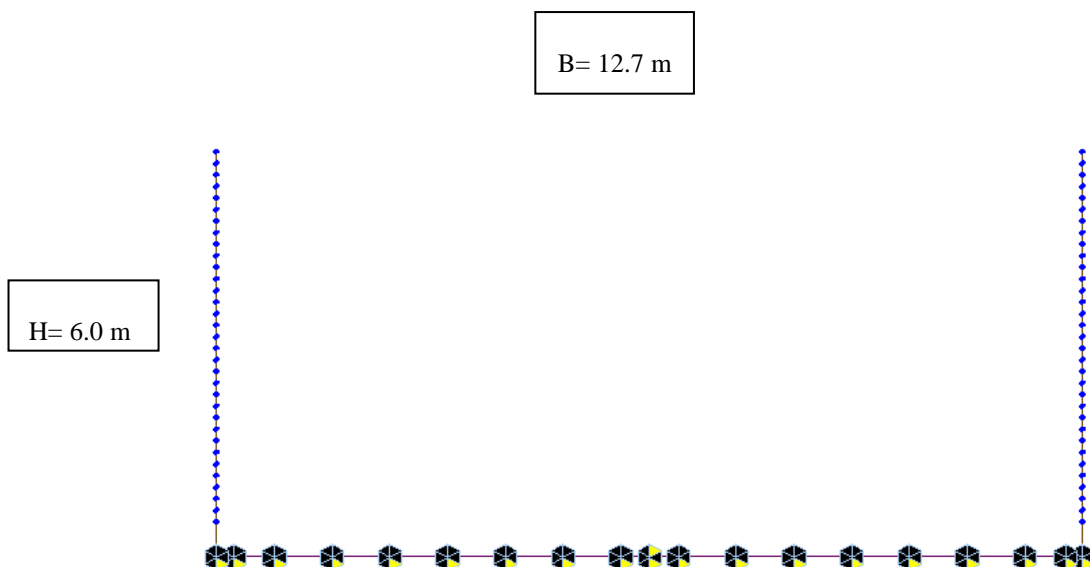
1^ modello strutturale su letto di molle con vincolo centrale allo spostamento orizzontale
